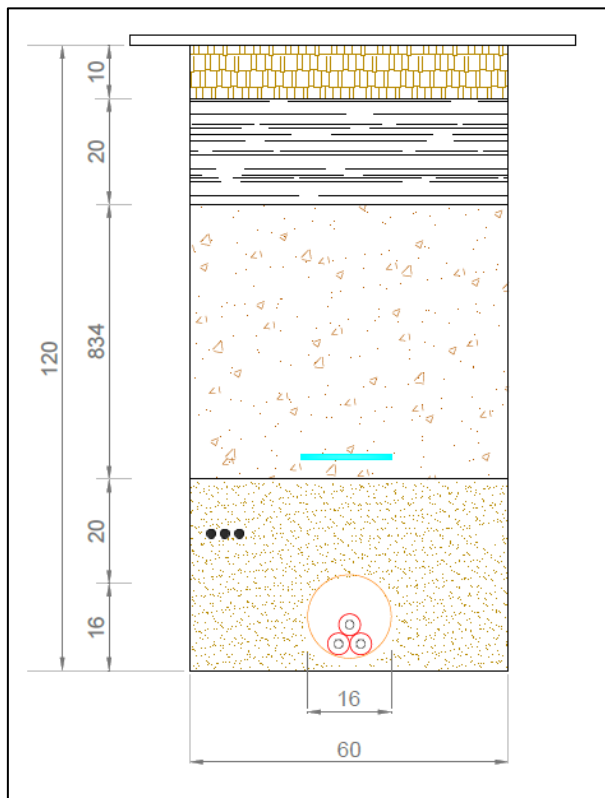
Sezioni di scavo previste nel progetto e legenda
